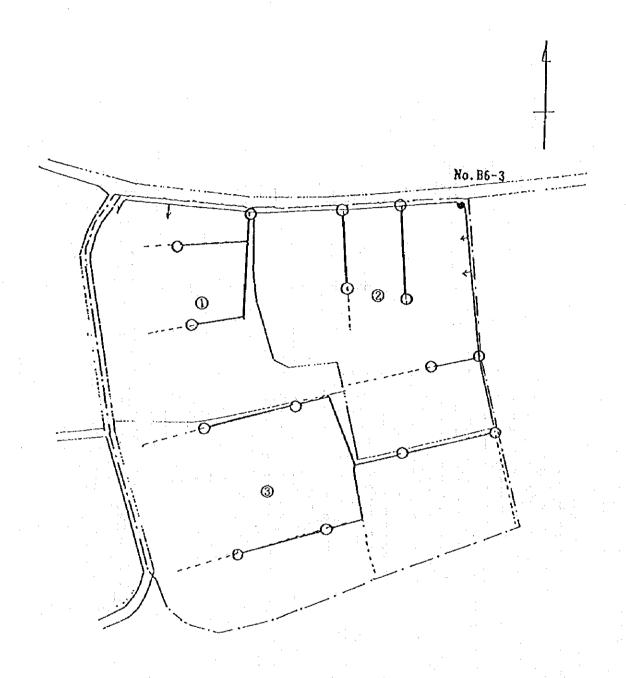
Plan horizontal du projet des installations terminales (Oued Shili)
